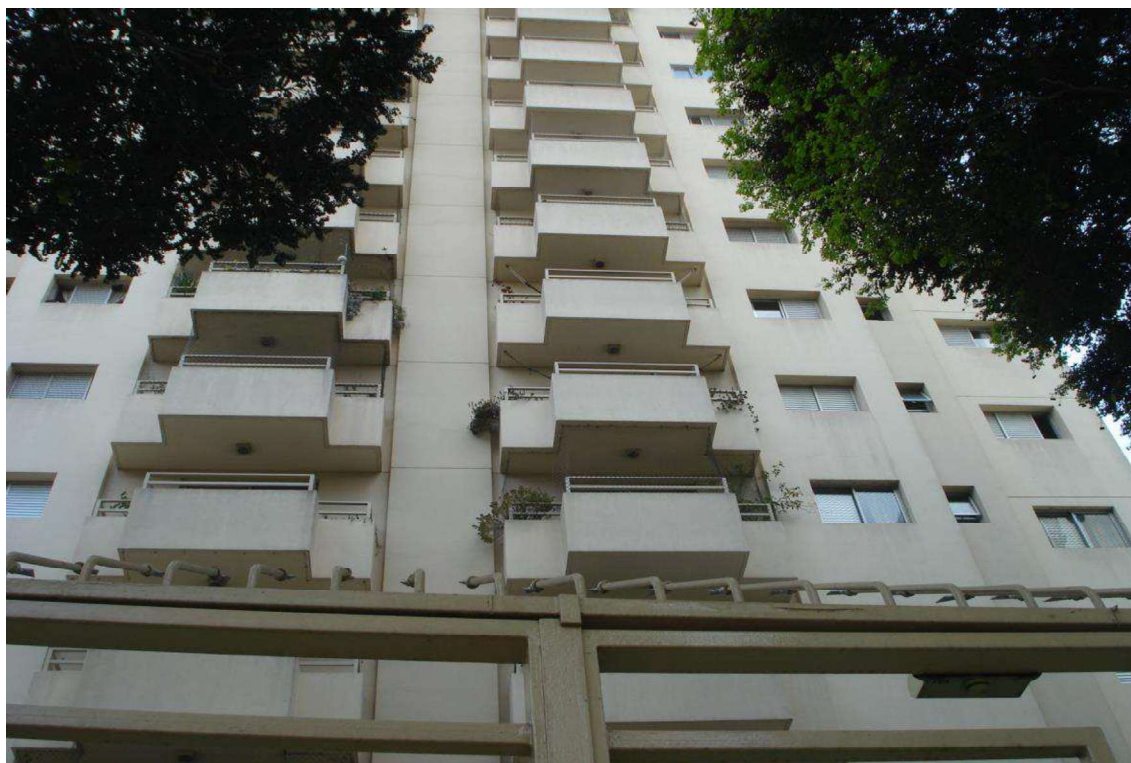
Vista da Rua Brigadeiro Galvão à direita do Edifício King Boris.
